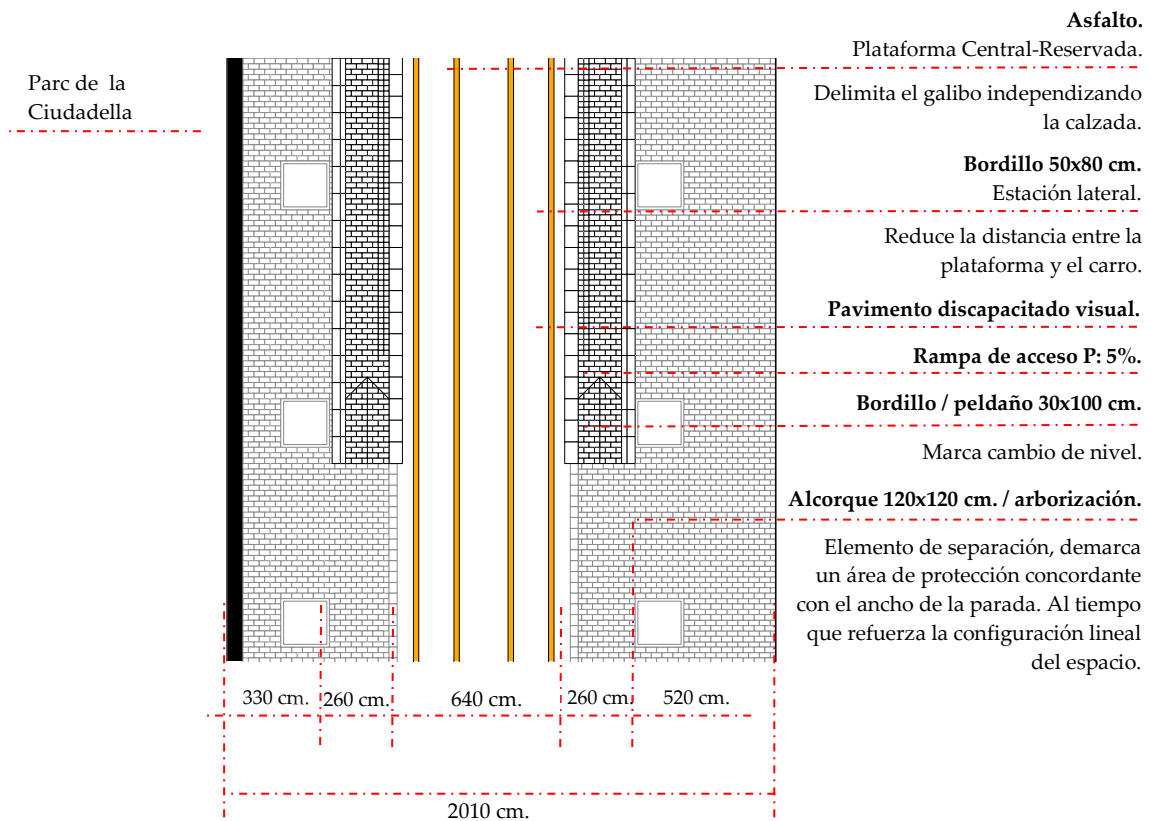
Planta de detalle B. Fuente: elaboración propia.
